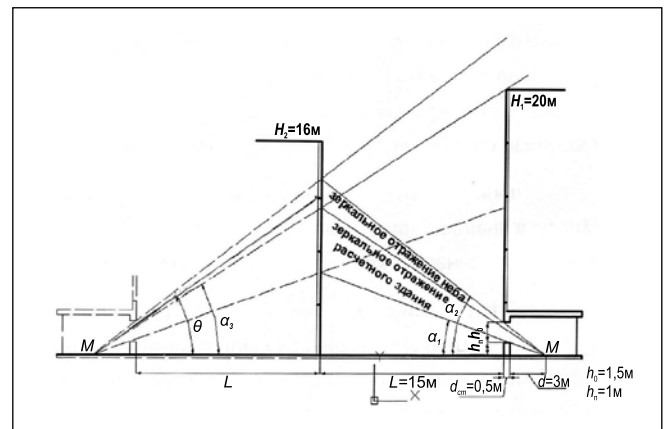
Схема к расчёту в примере с противостоящим зданием с зеркальным фасадом
